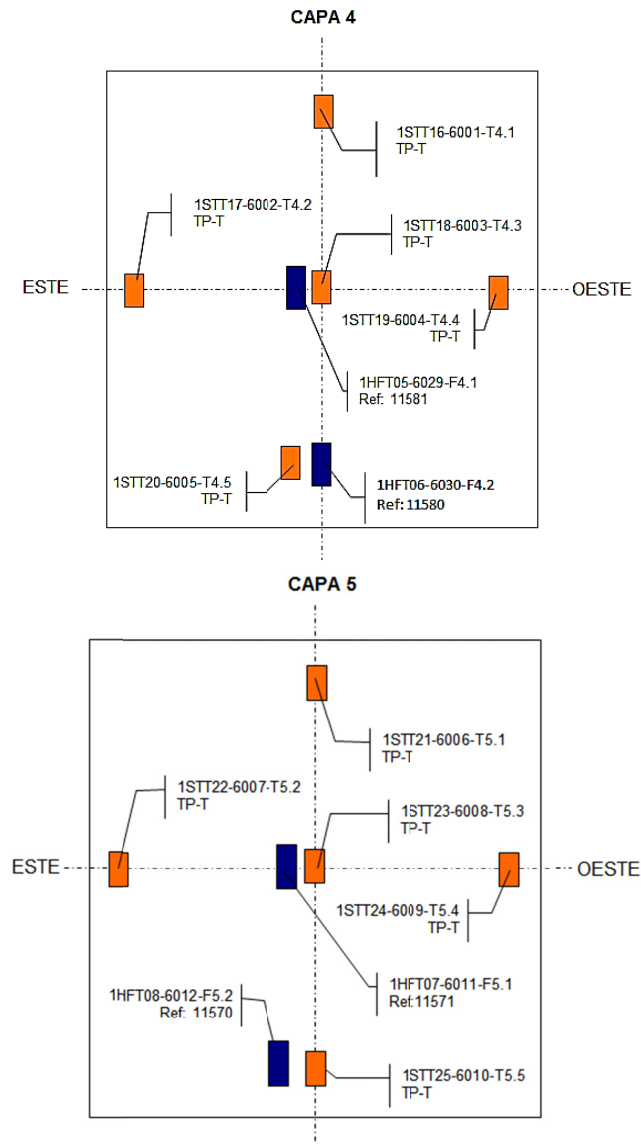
Instrumentación añadida al muro base con aislamiento
